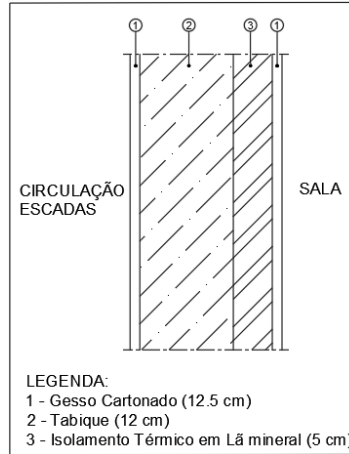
Pormenor construtivo da parede Sala / Circulação de Escadas
